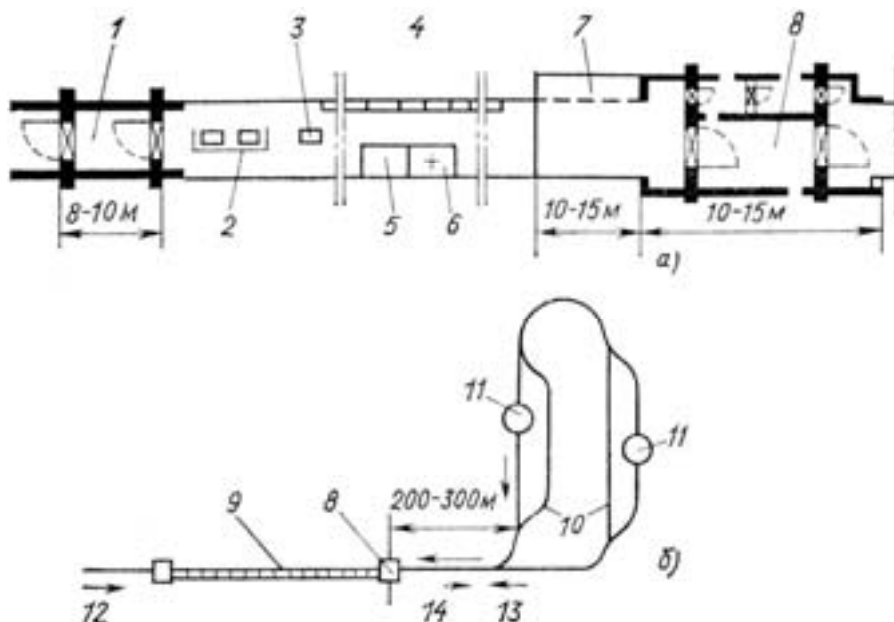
Схема планування сховища, що розміщене у гірничій виробці: а) схема сховища; б) схема вентиляції сховища; 1 – тамбур; 2 – санвузол; 3 – вагонетка з водою; 4 – нари; 5 – пункт управління; 6 – медпункт; 7 – фільтровентиляційна камера; 8 – тамбур-шлюз; 9 – сховище; 10 – шлях руху відпрацьованого повітря; 11 – вертикальні стовбури шахти; 12 – напрямок руху свіжого повітря при природній вентиляції; 13 – шлях руху персоналу при заповненні сховища; 14 – шлях евакуації персоналу.
